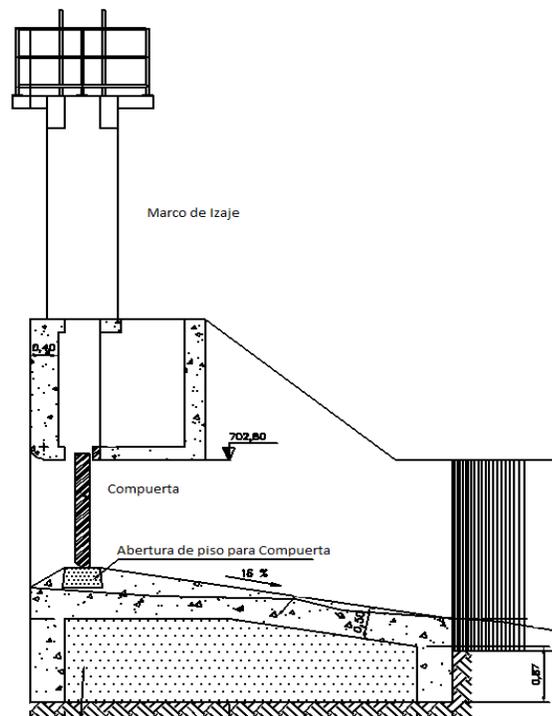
Corte transversal de Descarga de Fondo. Extraído de planos
